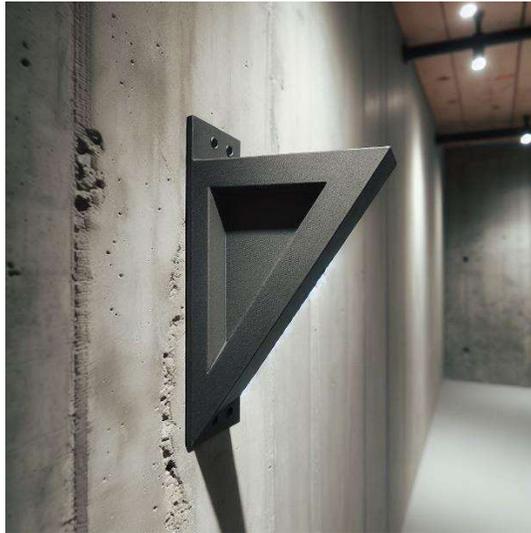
OpenAI. (2025). Dobles de acero de losa a vigas nuevas, imagen generada por IA.
